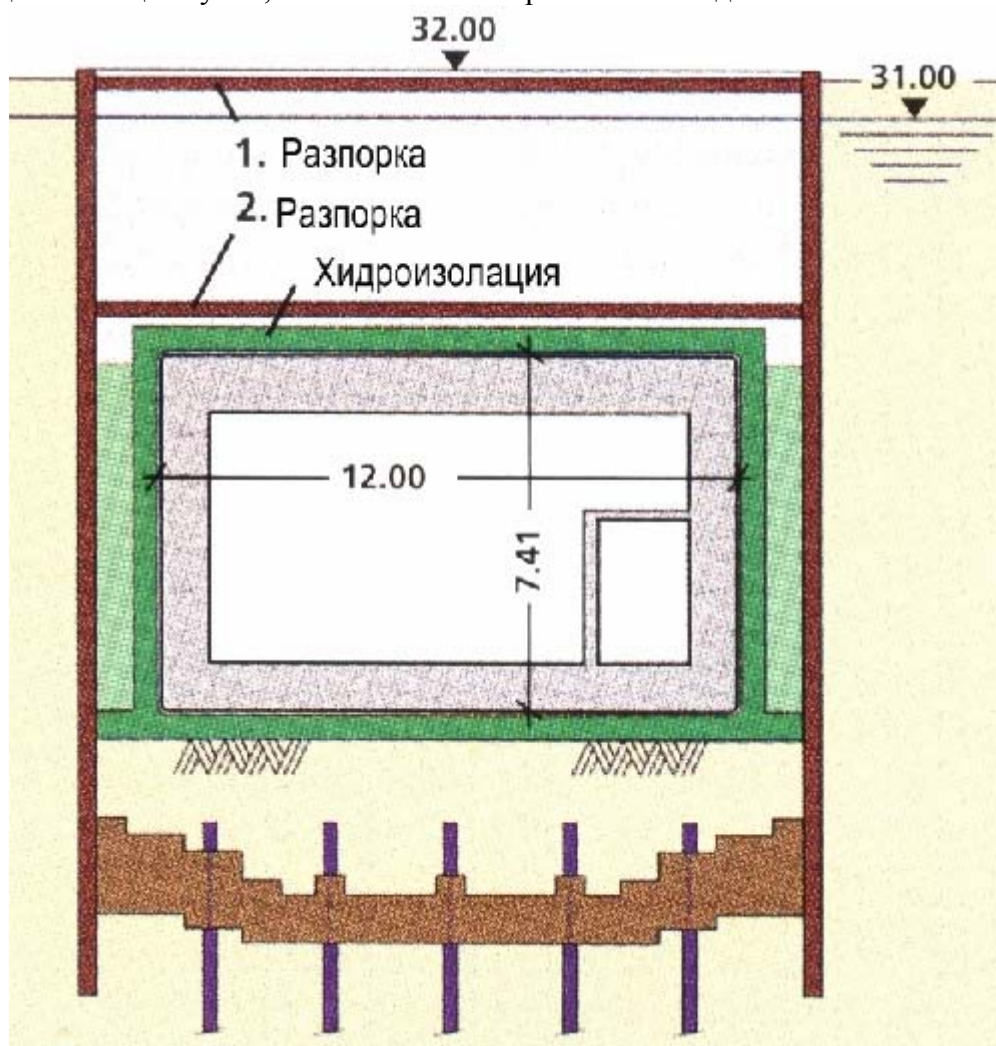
Напречен разрез тип 2-2 – изпълнение по котлованен метод като изкопът е укрепен със стоманен шпунт. Рамката е фундирана на стоманени пилоти под стените на правоъгълното сечение.
